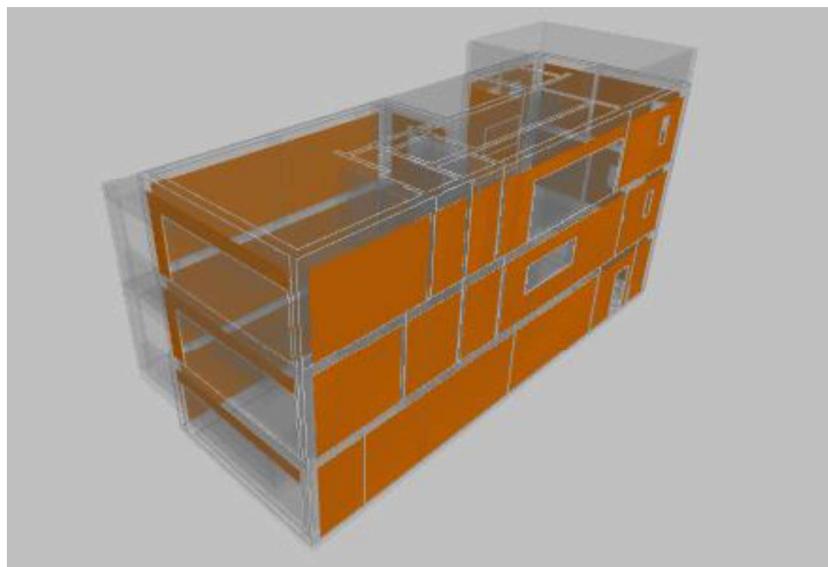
Situación del Cerramiento Fachada exterior en la vivienda. CYPETHERM HE Plus
